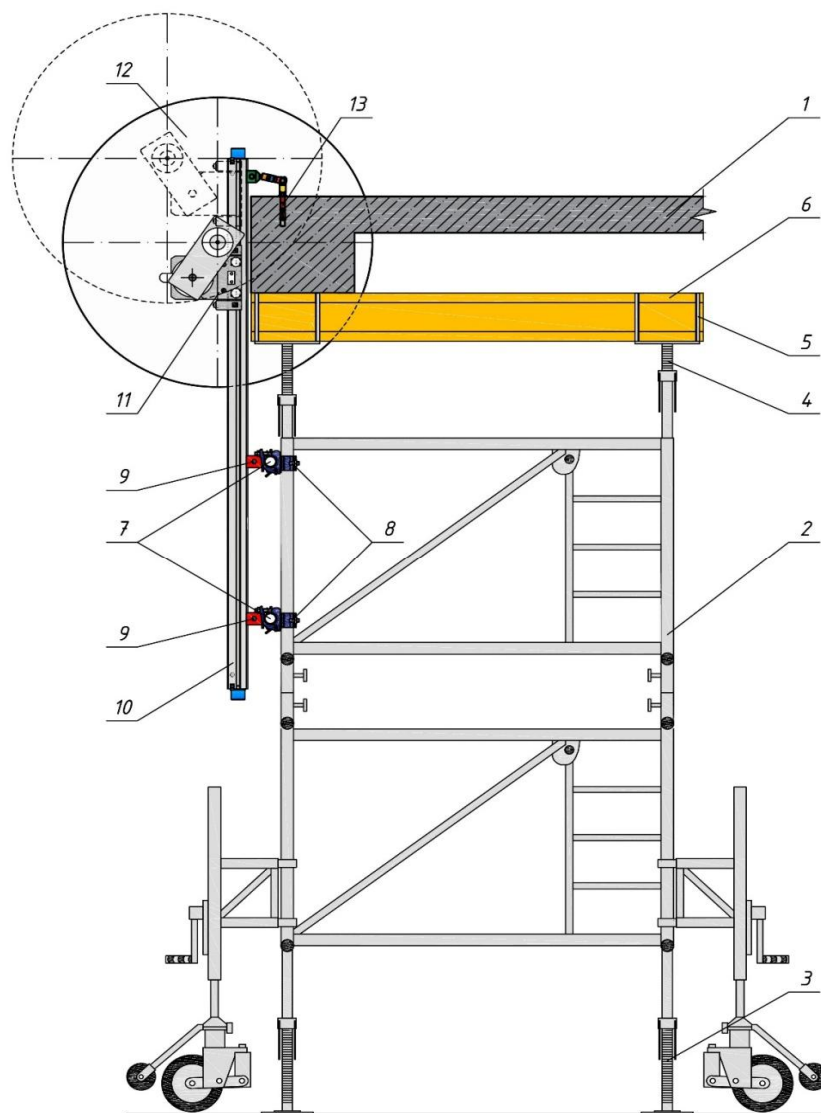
Общий вид усовершенствованного оборудования для алмазной резки железобетонных конструкций перекрытия
